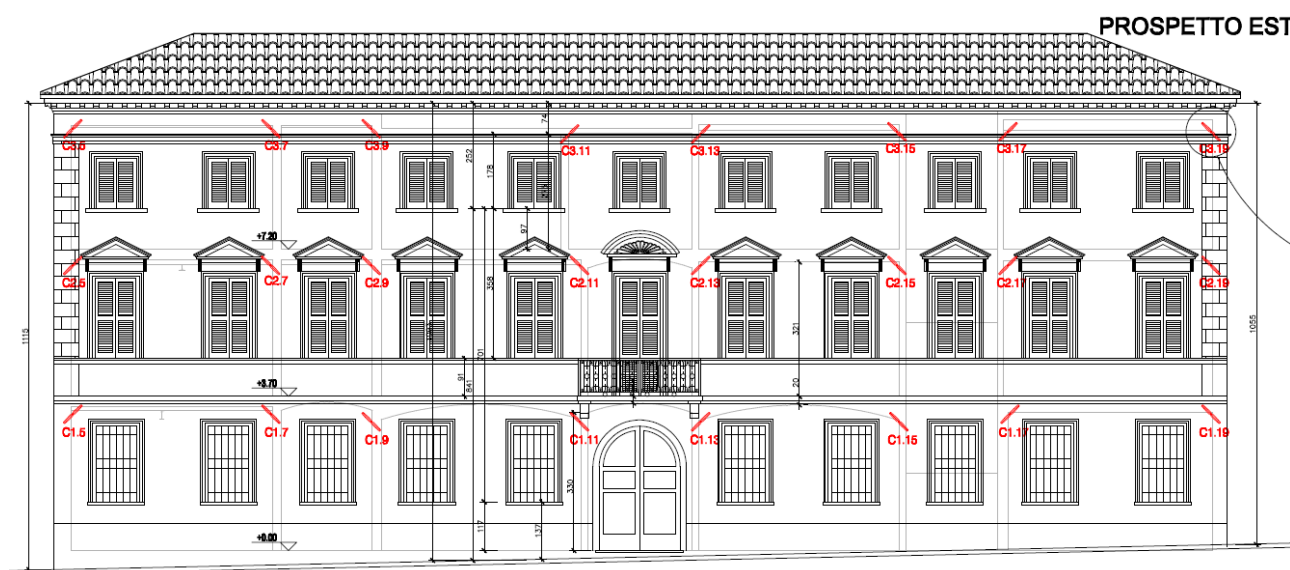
| Prospetto Est – Disposizione in prospetto dei capochiave
